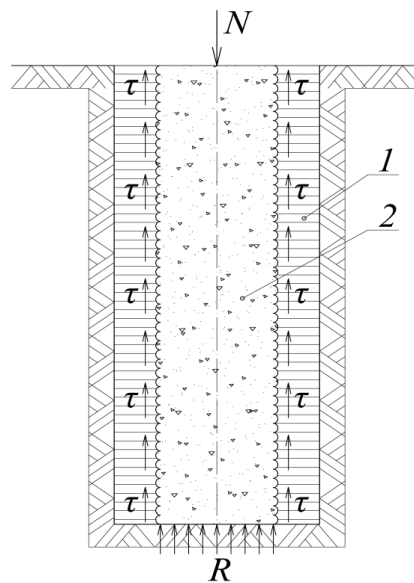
Схема к определению несущей способности сваи SFA (НПШ) по грунтоцементному основанию
